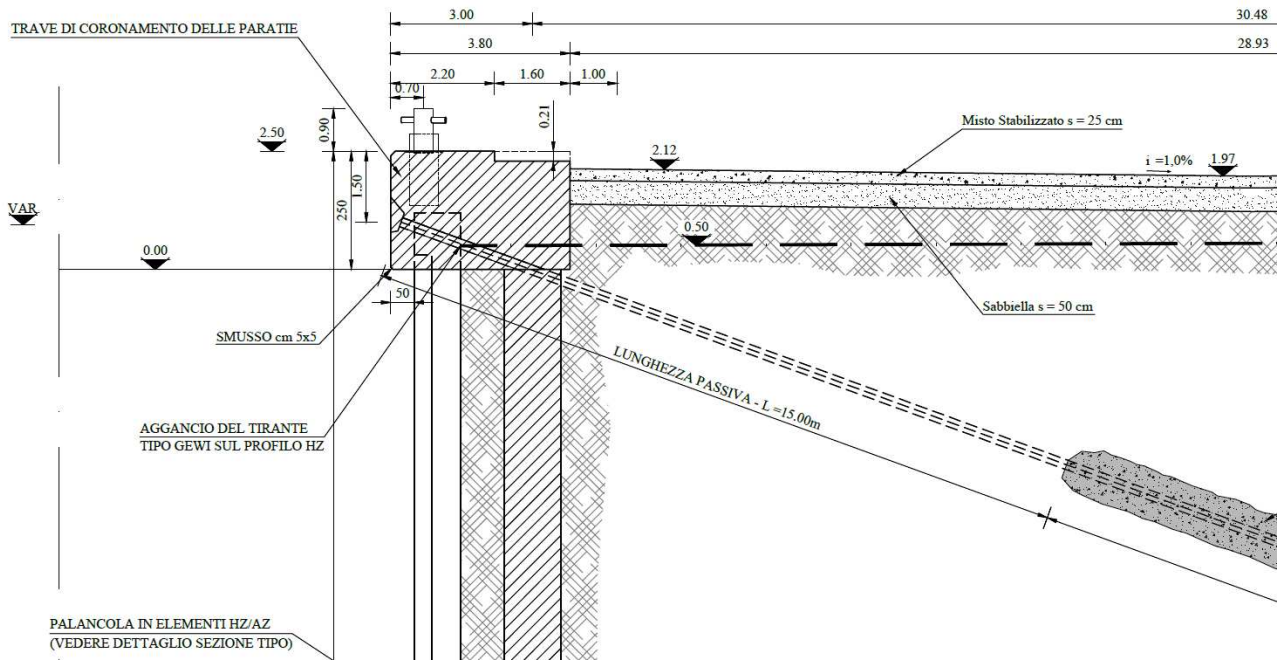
Estratto da elaborato del PD - 1114.STR.10.02 - Stato Attuale Planimetria e Sezioni_Rev.2
